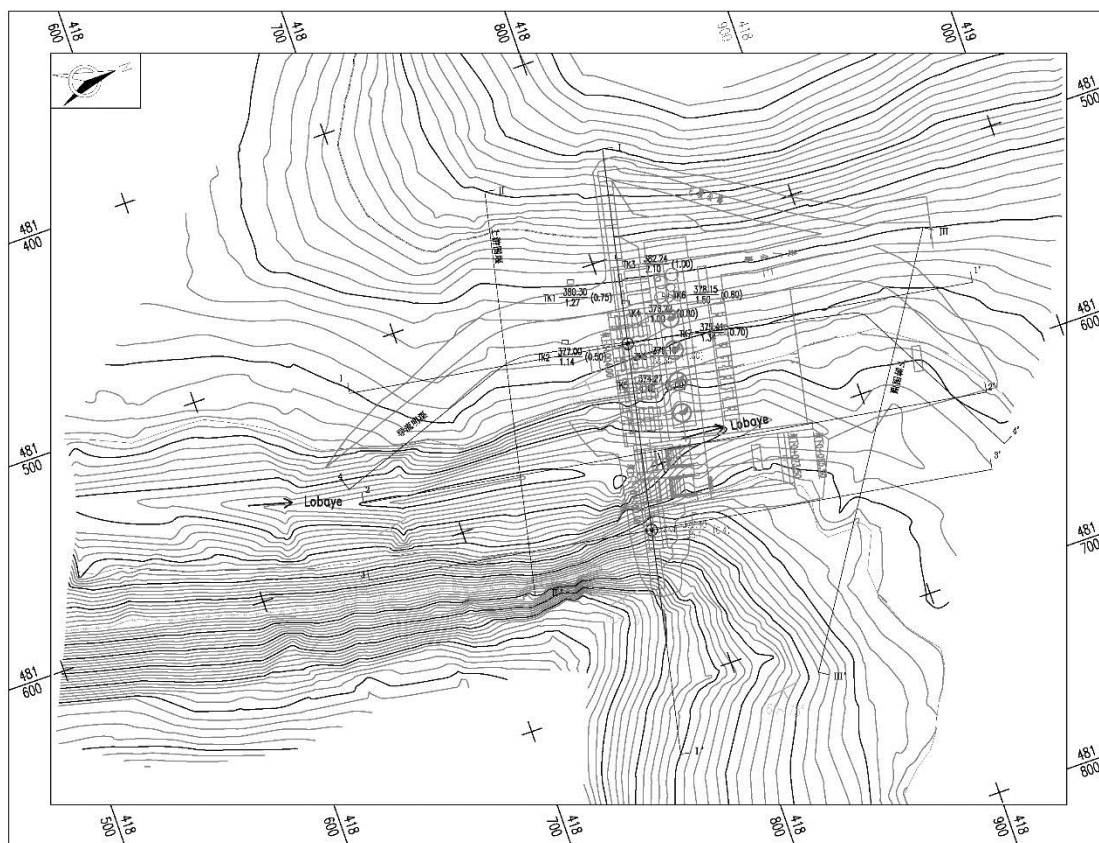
Plan d'implantation du forage de la centrale hydro électrique de BAC ZK3, ZK4
